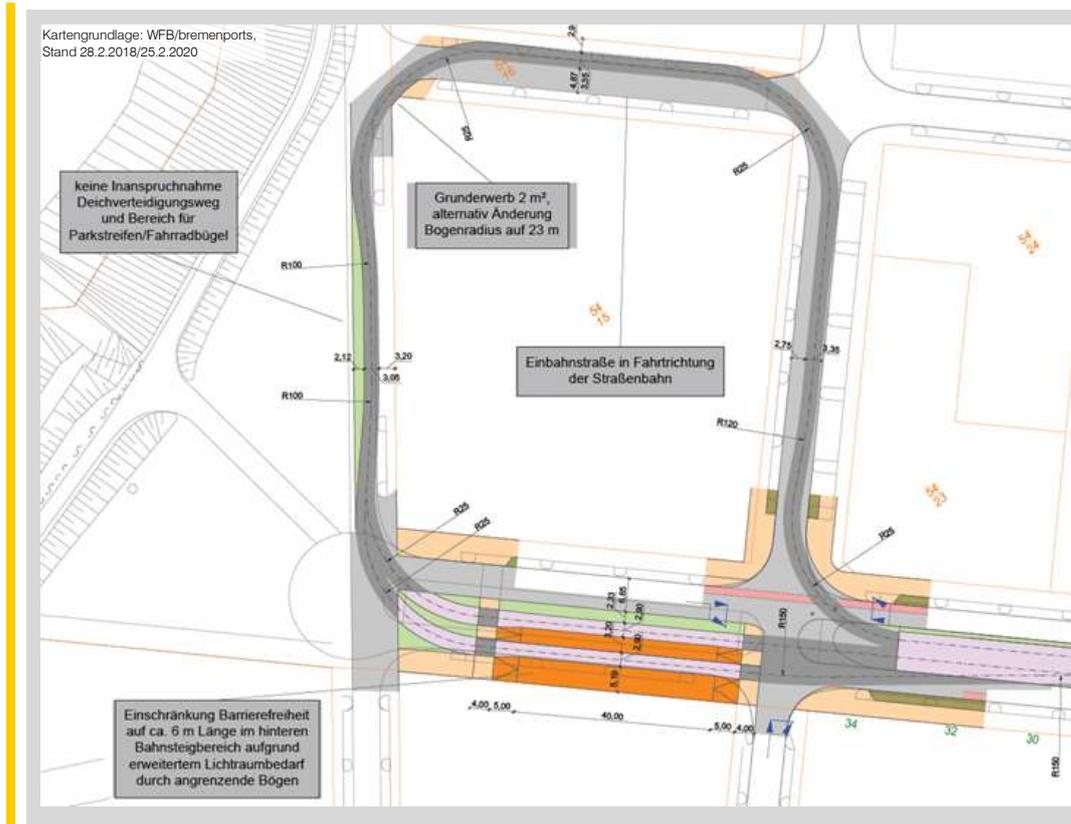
Lageplandarstellung Blockumfahrung Waller Sand
